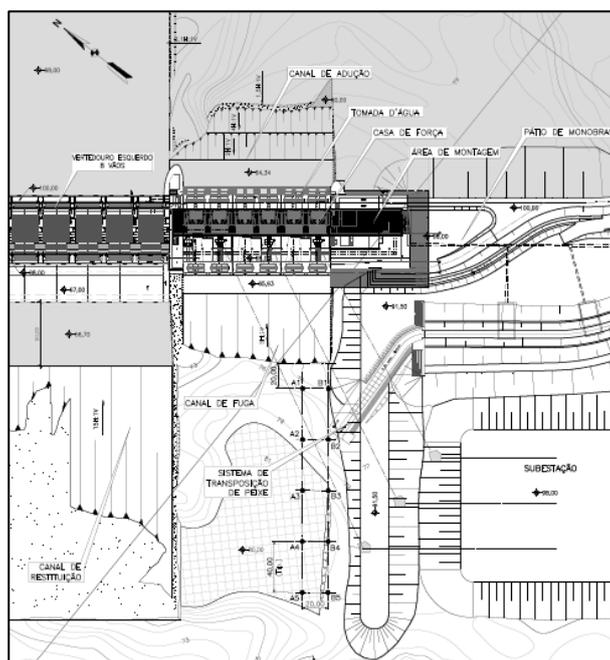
2a – Arranjo em planta da Alternativa Inicial para dique junto à entrada do STP (Anexo 1, LEME (2012a)).
